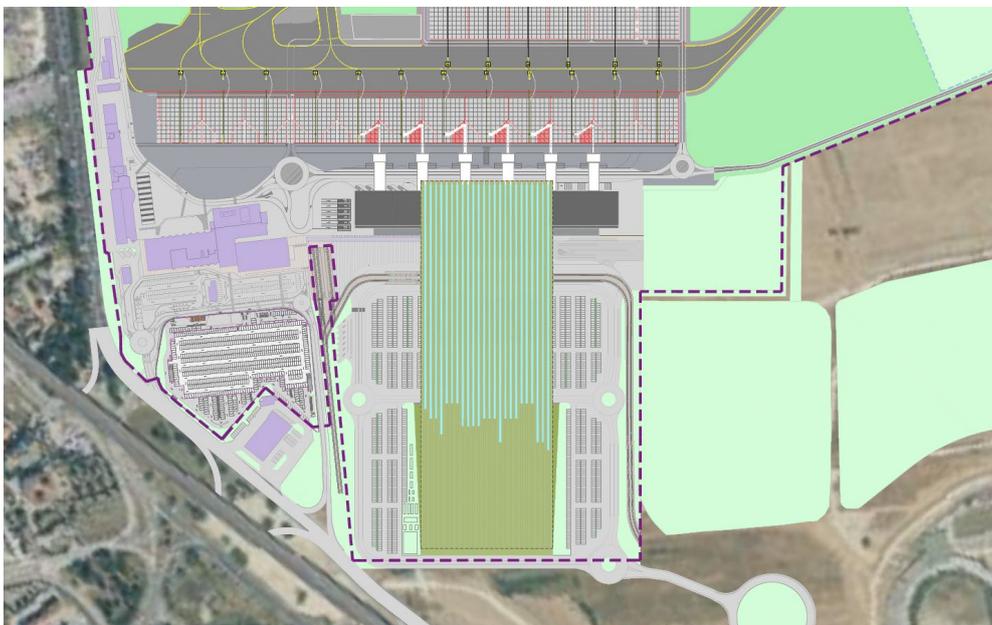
Planimetria generale di Futura espansione Terminal e Piazzali al 2035
